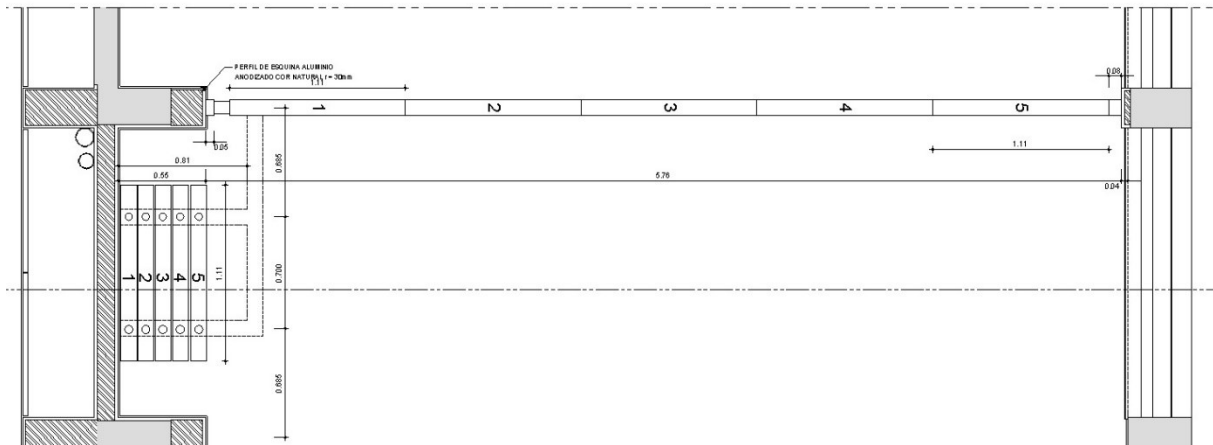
Planta das salas de biblioteca e informática (s/escala).
